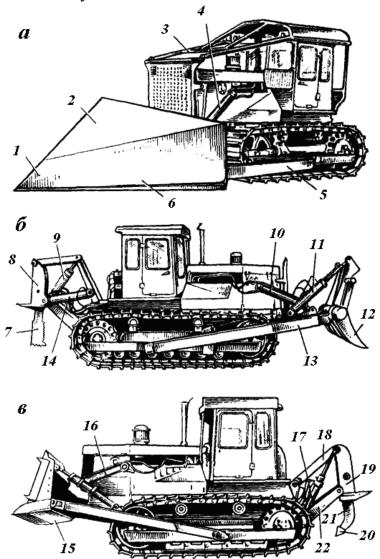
Машины для подготовительных работ: a – кусторез; b – корчеватель-собиратель; b – рыхлитель
